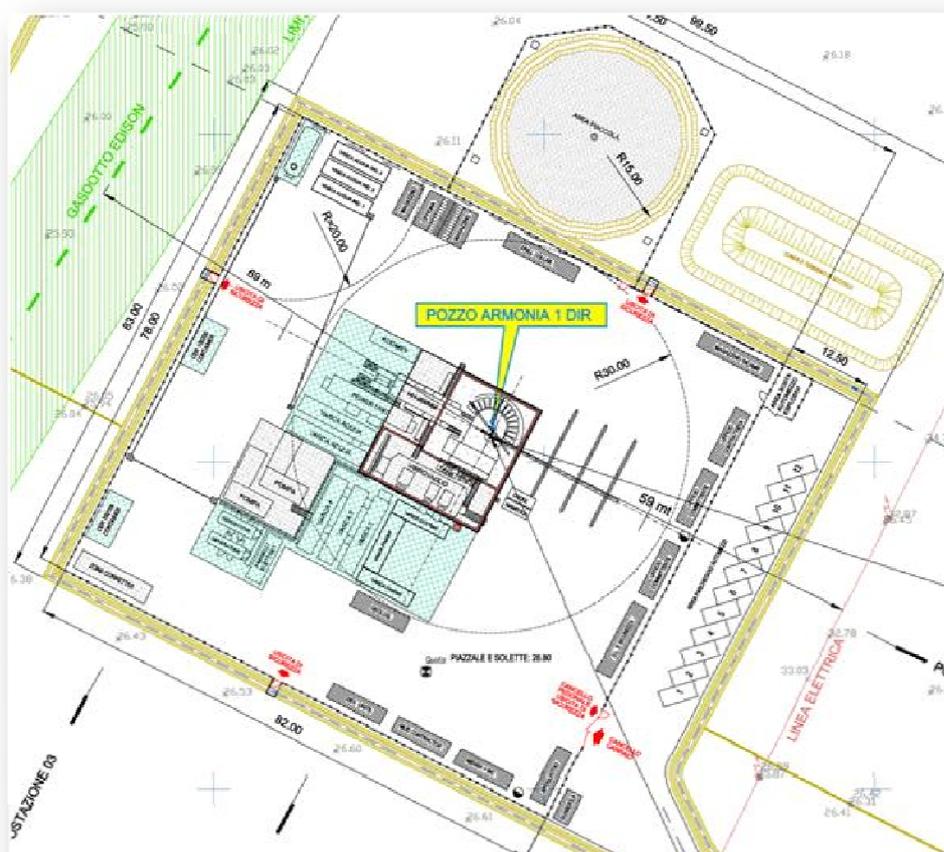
Layout della postazione futura del Sondaggio Armonia 1 dir
